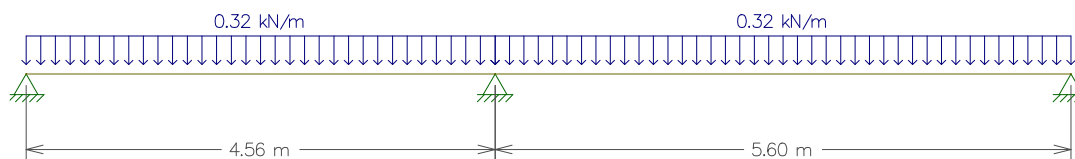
Esquema da estrutura de suporte do pavimento do piso 01
